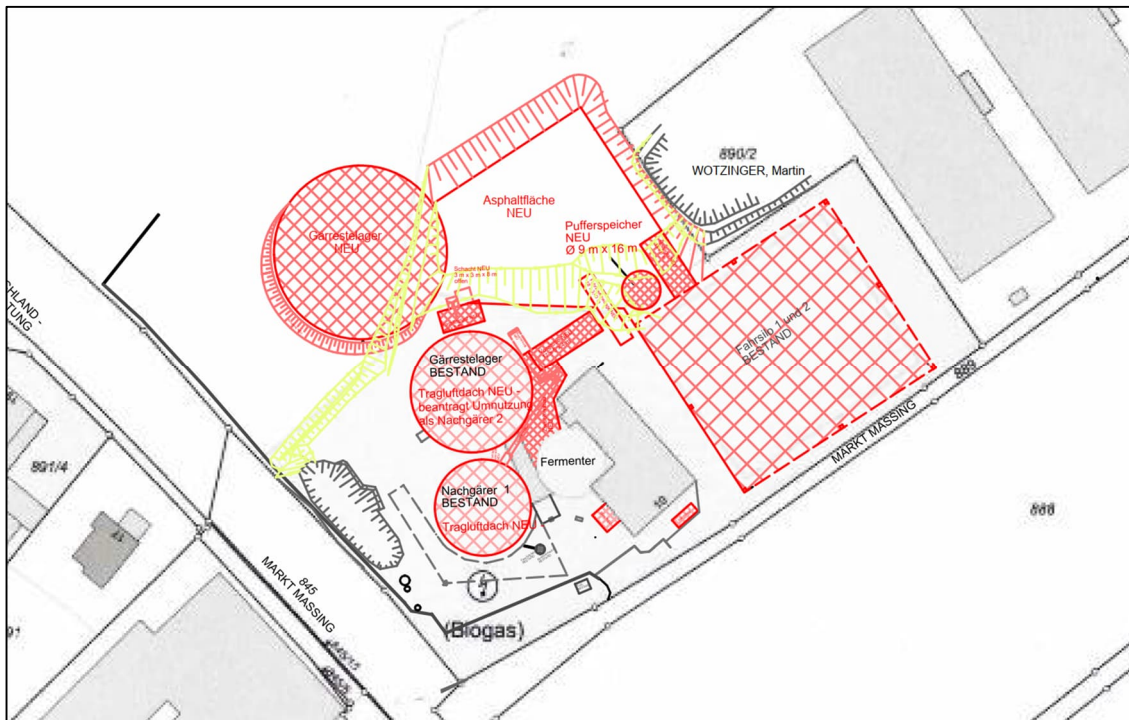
Lageplan mit Eintragung der geplanten Erweiterung (rot) /22/
